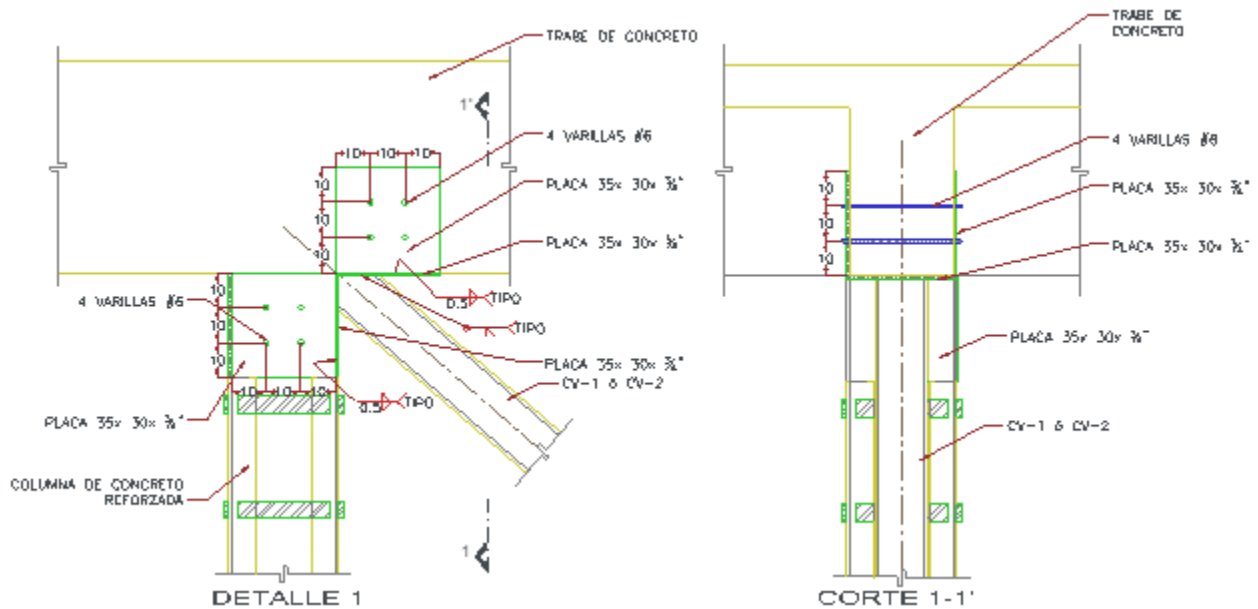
Detallado del sistema de refuerzo en las conexiones del proyecto de refuerzo del Edificio Amsterdam, tomado planos estructurales de Romo Heredia (2020).
